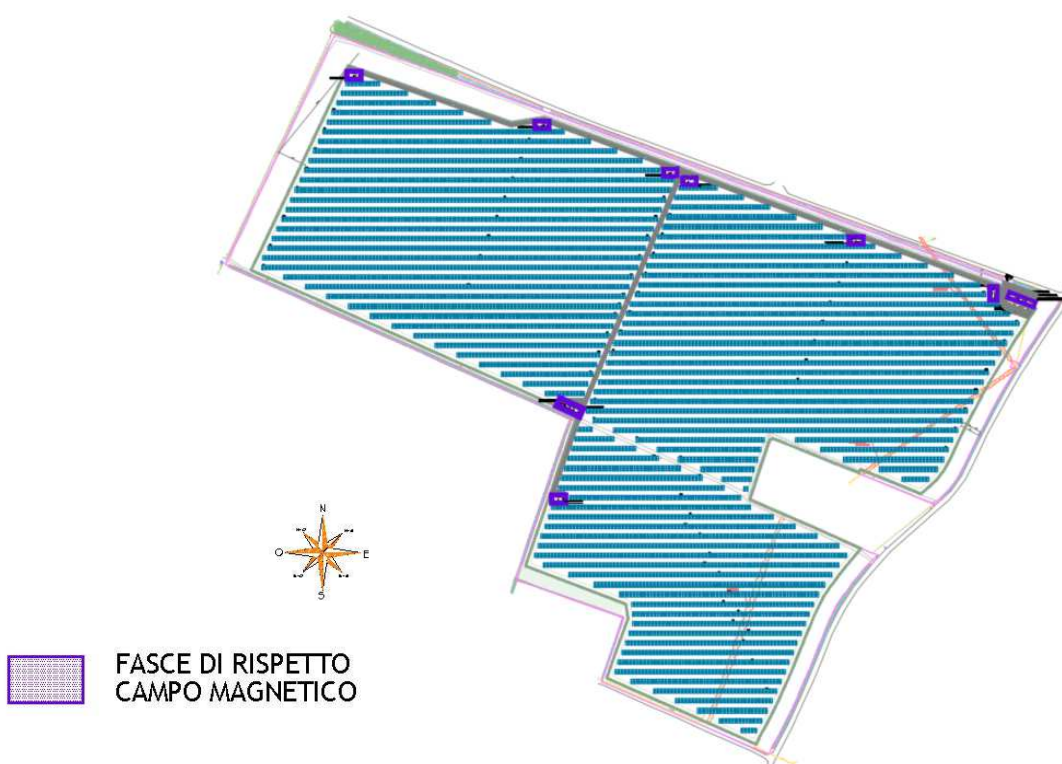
Planimetria generale individuazione fasce di rispetto determinate
